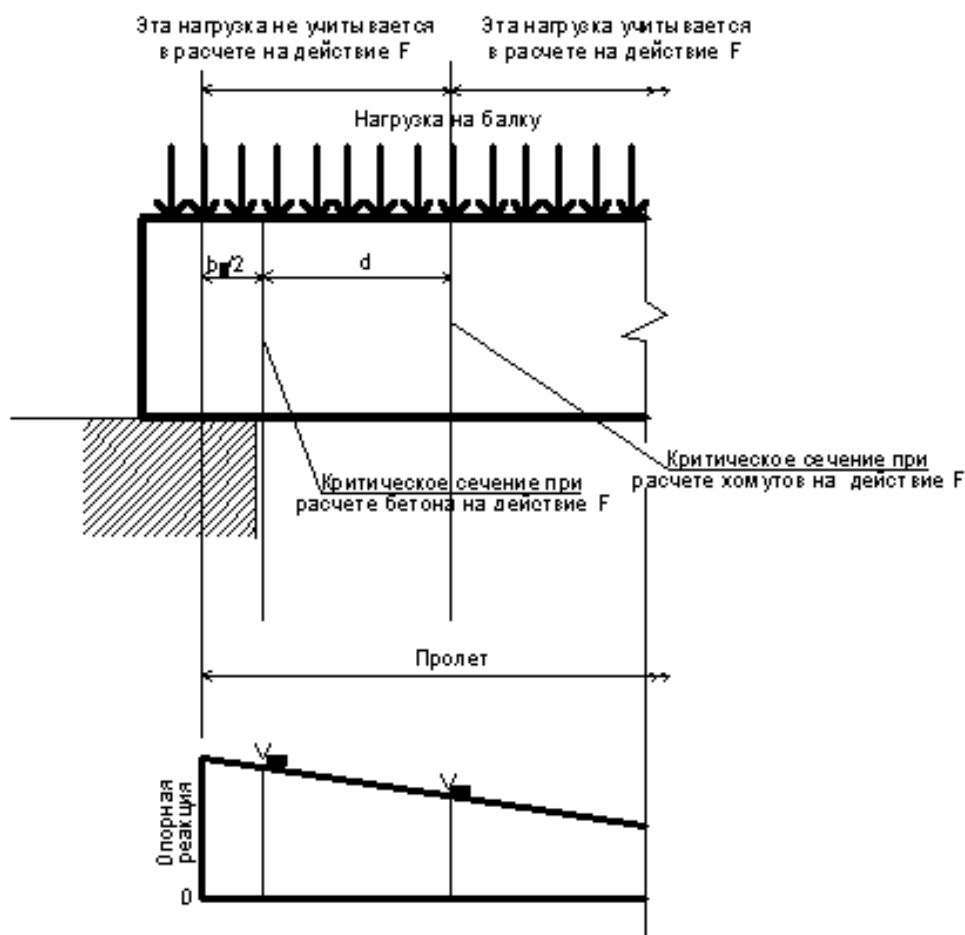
Критические сечения для расчета балки на действие поперечной силы
